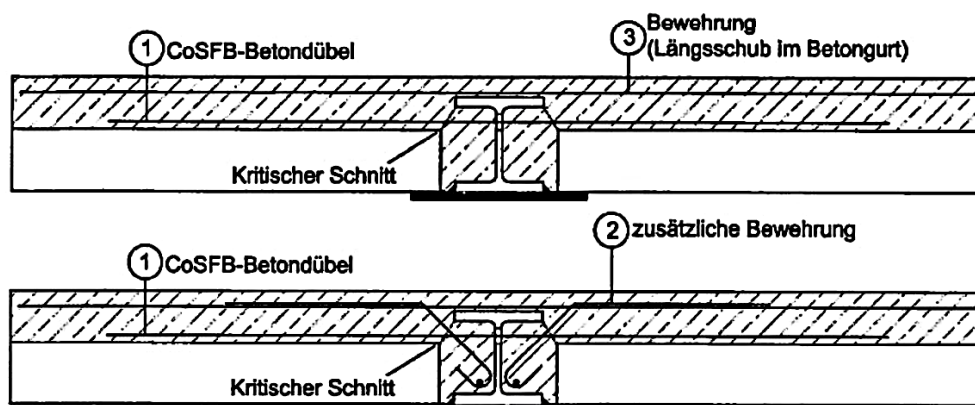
Corte longitudinal em soluções com concrete-dowels: plano de corte relevante (“*Kritischer Schnitt*”), com identificação de: armadura do *concrete-dowel* - (1); armadura da laje - (3); armadura de reforço típica para o corte longitudinal - (2), (DIBt, 2014).
